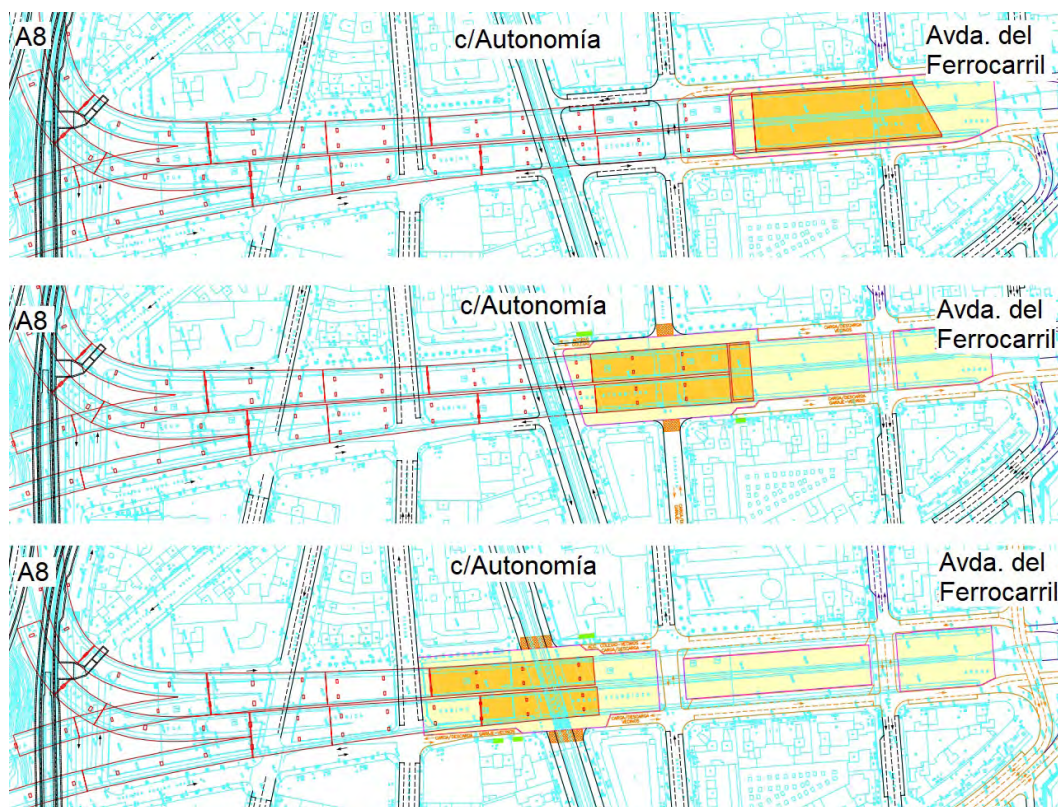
Capturas en planta del avance de la demolición, entre la Avda. del Ferrocarril y la autopista A-8.
